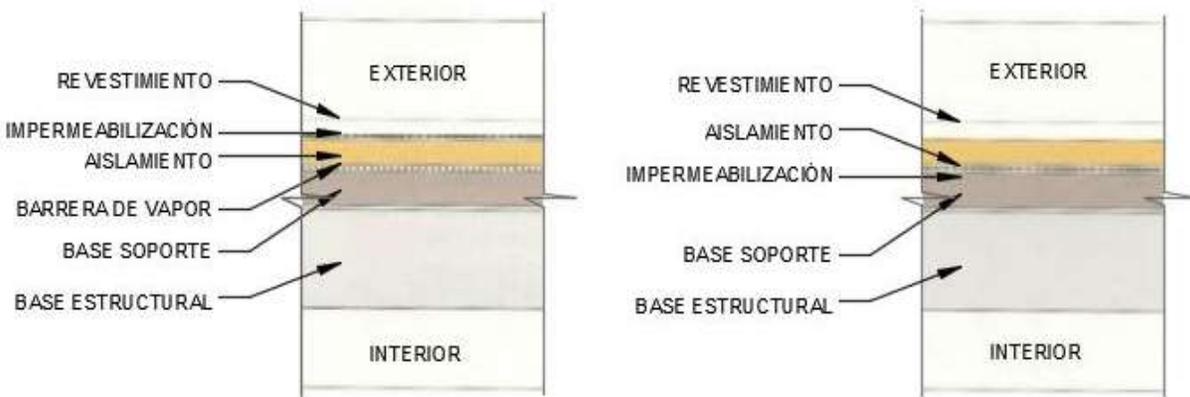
Capas que componen una cubierta plana fría ventilada.
